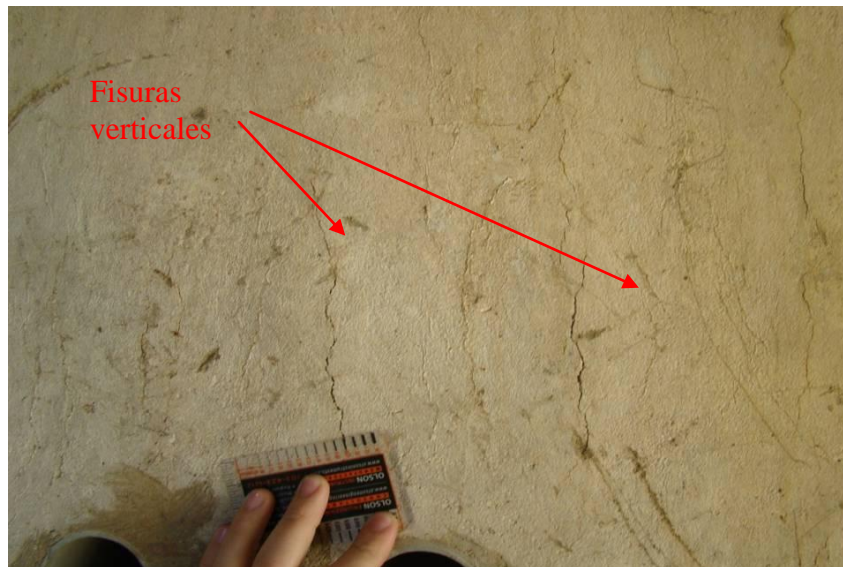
Detalle de fisuras verticales en viga 3 del tramo 2.
